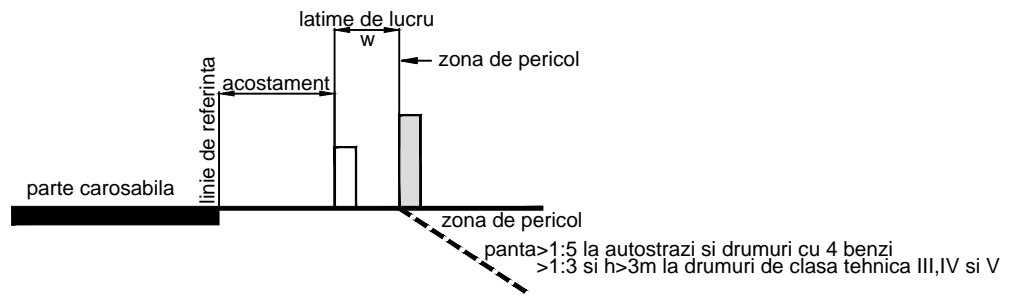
Pozitia parapetelor de siguranta fata de latimea de lucru si partea carosabila (parapet marginal)
